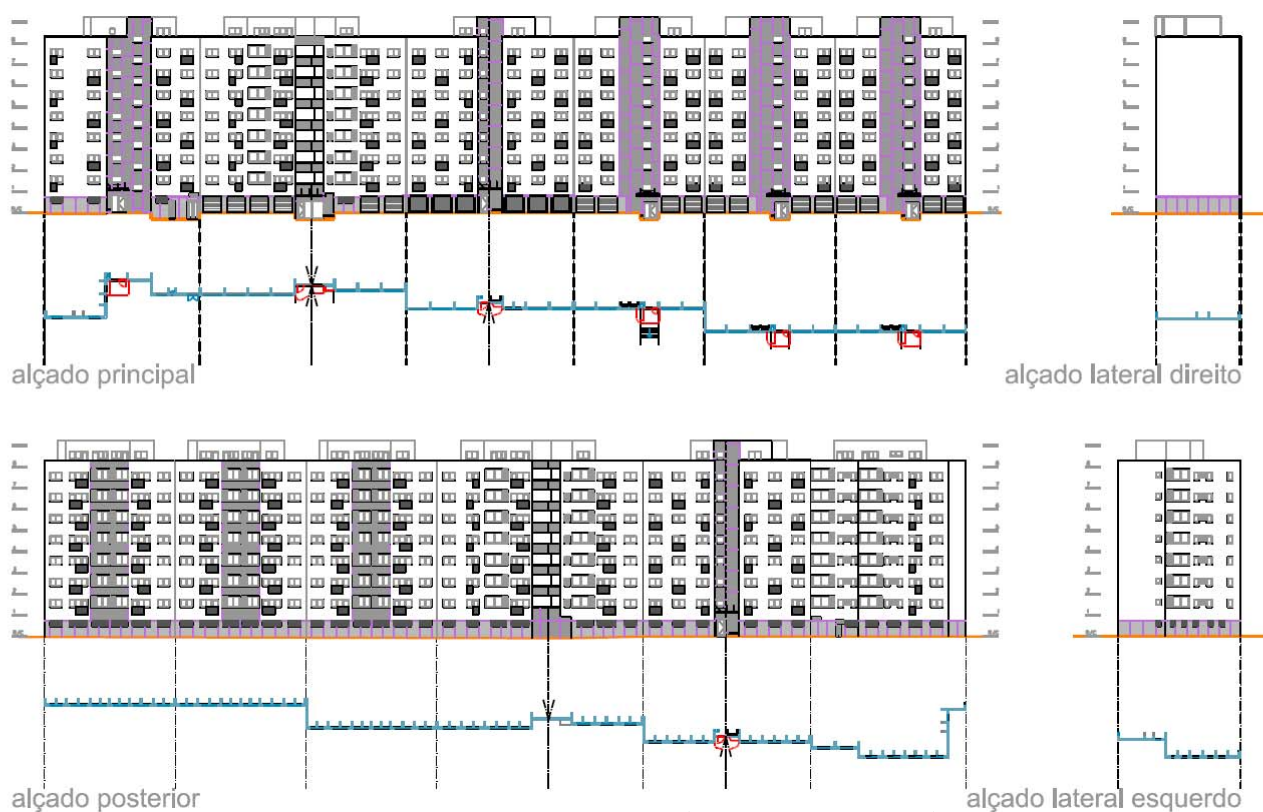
Bloco 10. Intervenção (alçados, escala 1/1000).
